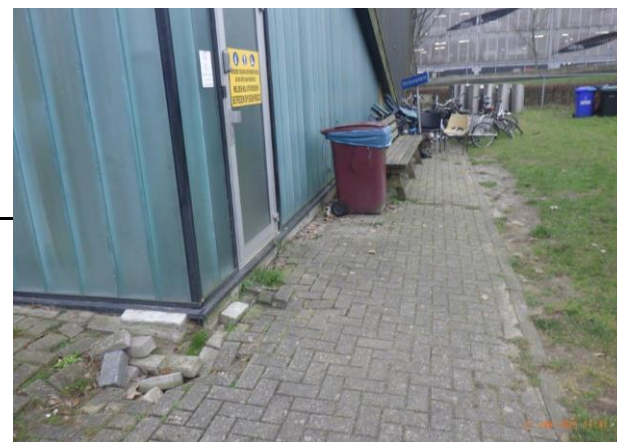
Straatwerk verzakt op enkele plaatsen.
